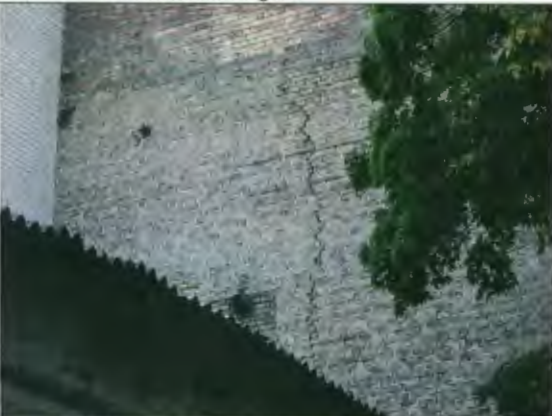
Vertikāla plaisa austrumu fasādē
